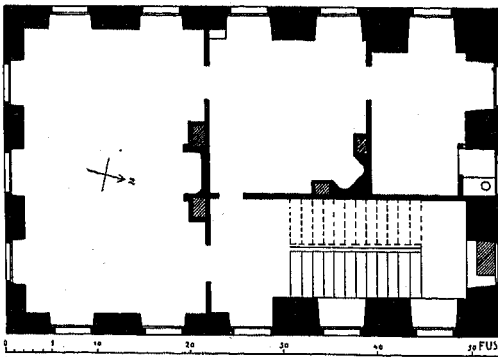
Holzhausense Oede; Grundriss des ersten
